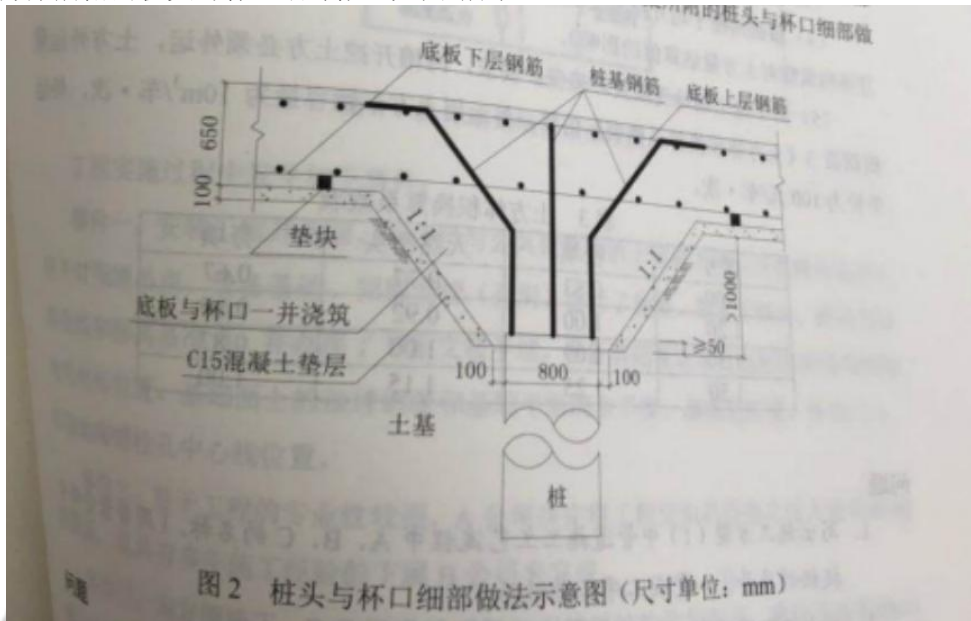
桩头与杯口细部做法示意图 (尺寸单位: mm)
